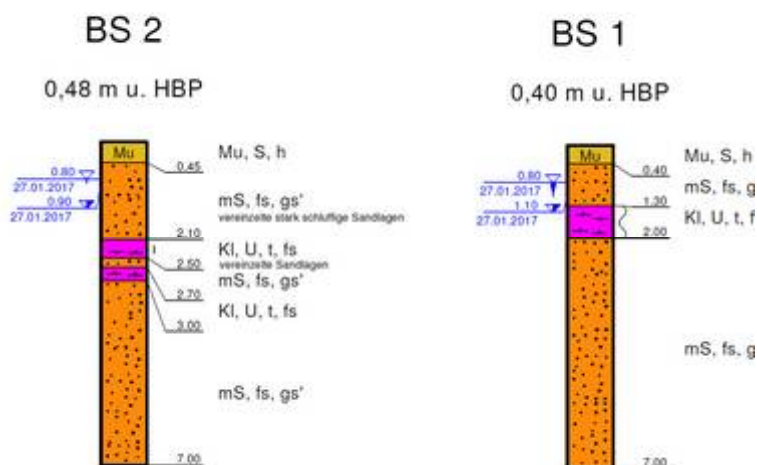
Auszug Baugrunduntersuchung, Lageplan Bohrprofile, Baugrundlabor Lüneburg
